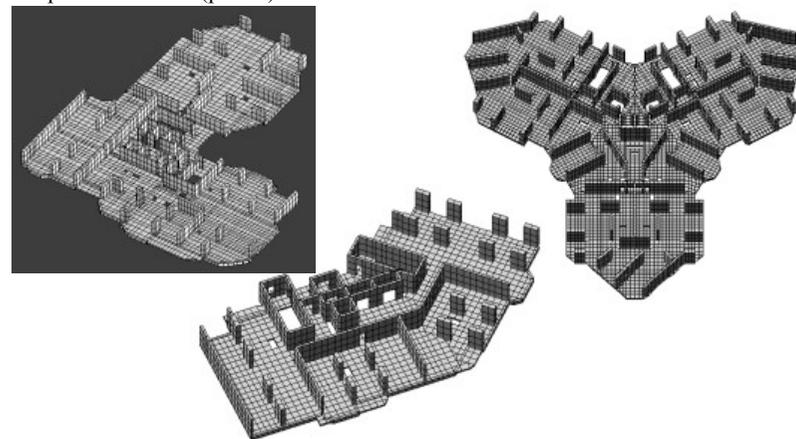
Конструктивные схемы некоторых жилых высотных зданий
